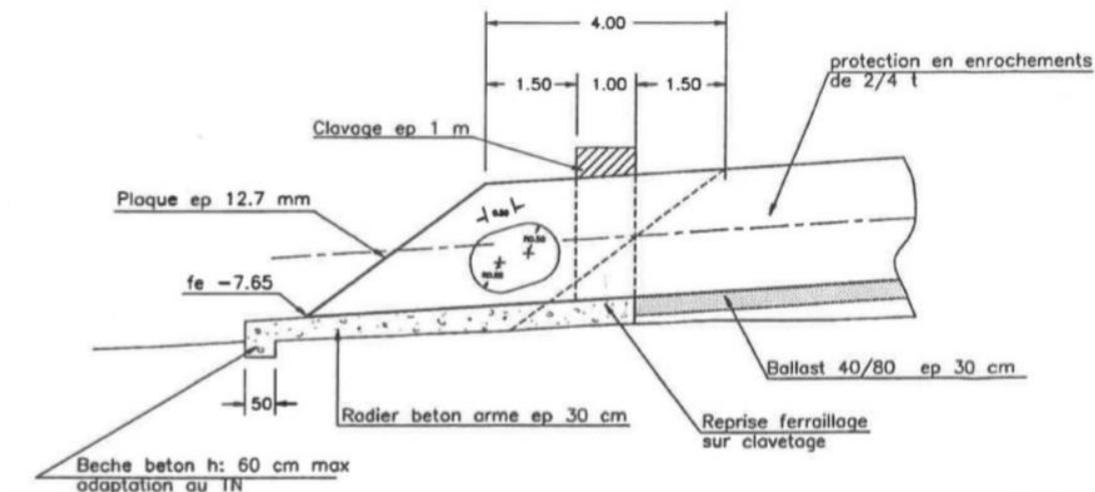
Coupe longitudinale du diffuseur - échelle 1/100 (source SPADA 1993)
